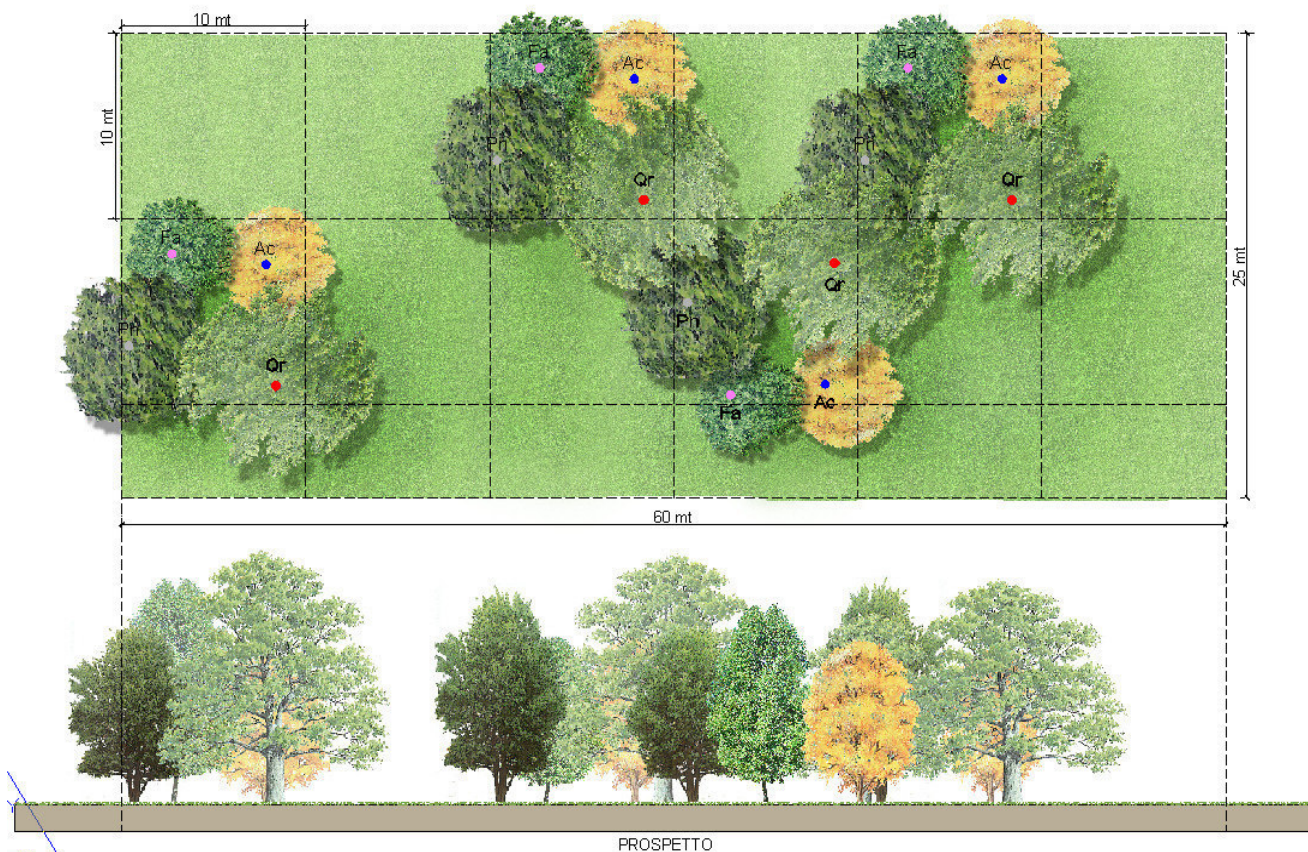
Pianta e prospetto della sistemazione del prato con alberi
